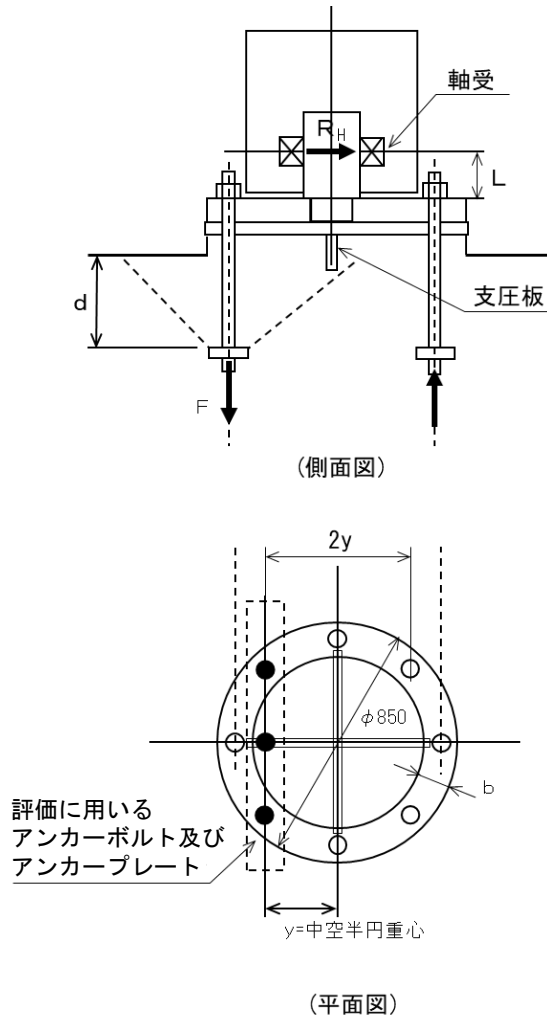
下部支承（アンカーボルト）及び下部支承（コンクリート）の評価イメージ図
